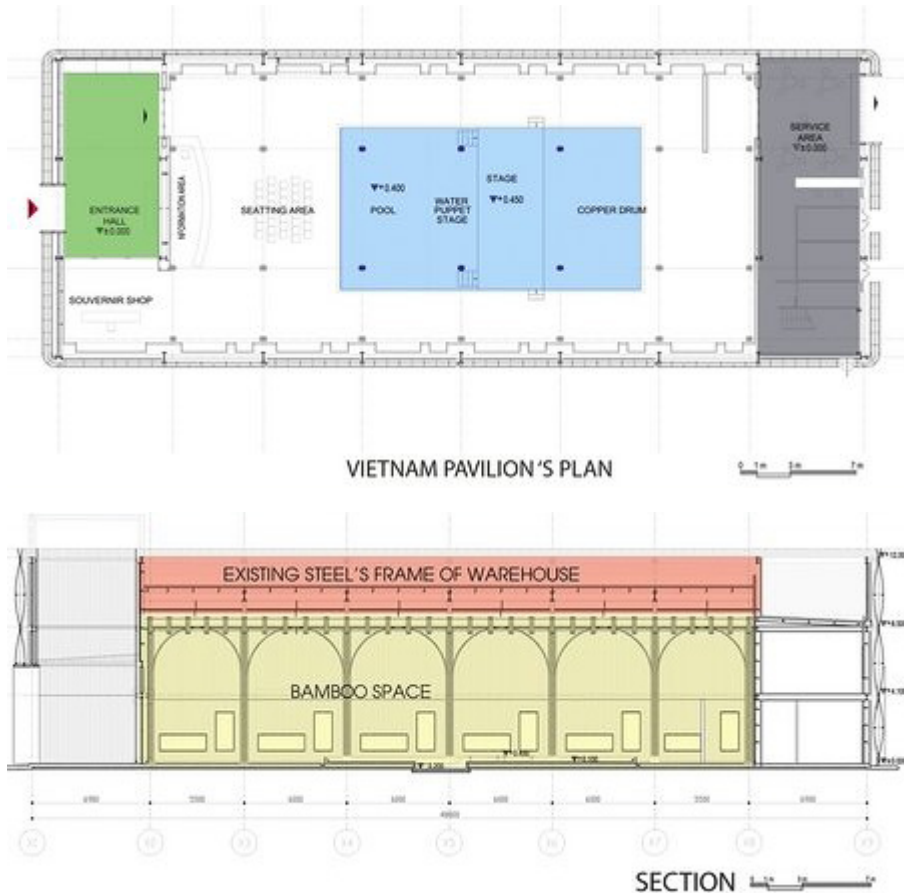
Planta y sección del pabellón. Fuente: *World Buildings Directory*<sup>118</sup> (2010)
